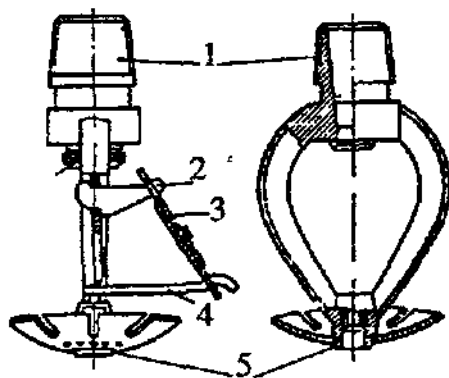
а) спринклерна головка, б) – дренчерна головка 1 – корпус зі штуцером, 2, 4 – коромисла запірної замка, 3 – легкоплавкий замок, 5 – розетка
